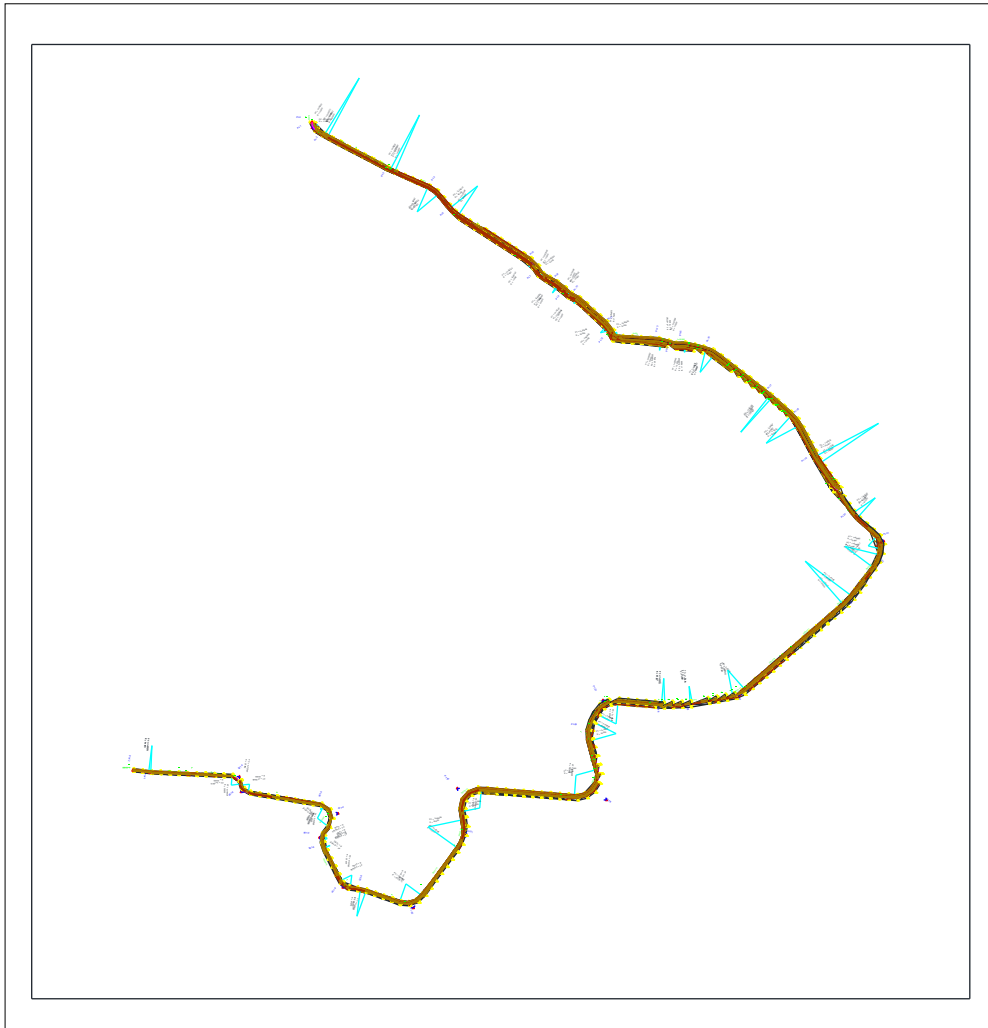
Planteamiento General del Sistema de drenaje pluvial.
